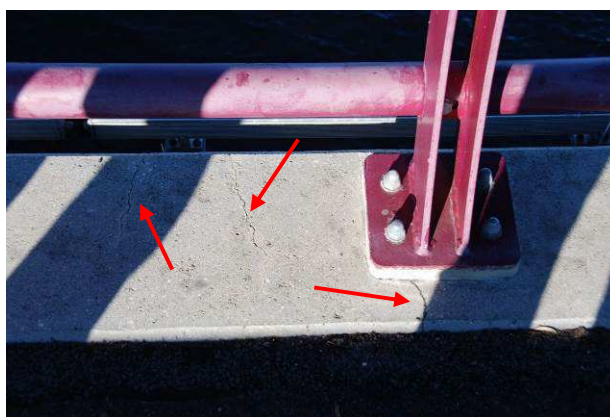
att. Plaisas laiduma konstrukcijas sānu sijā.
